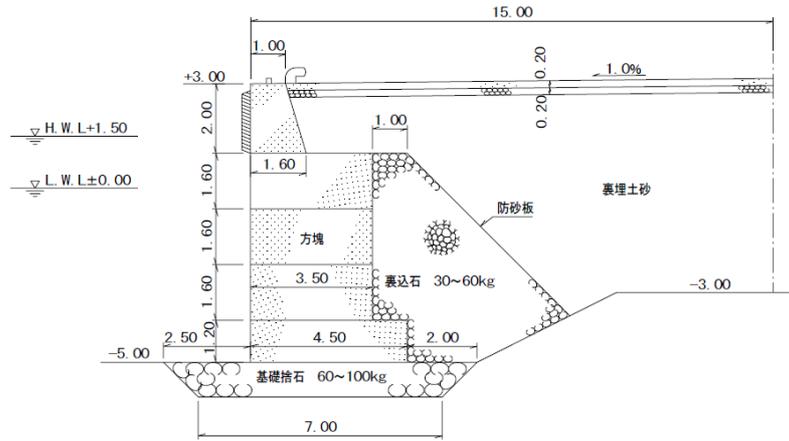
No.29 大洗港区_第1埠頭 C岸壁 (-5.0m) (水産ふ頭地区) の断面図 (被災前)
